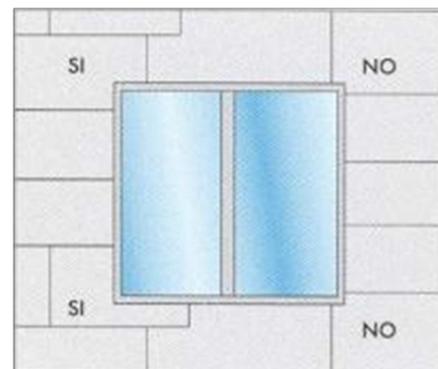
Detalle de la instalación de los paneles de aislamiento en las esquinas de los huecos.
